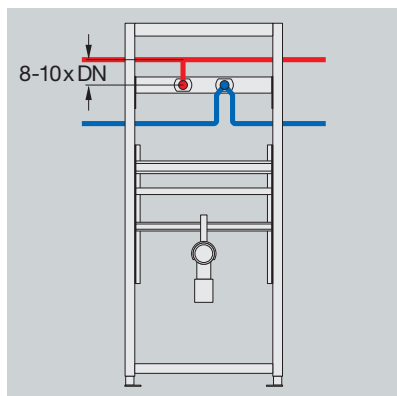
16 Troço de arrefecimento em torneira de parede
